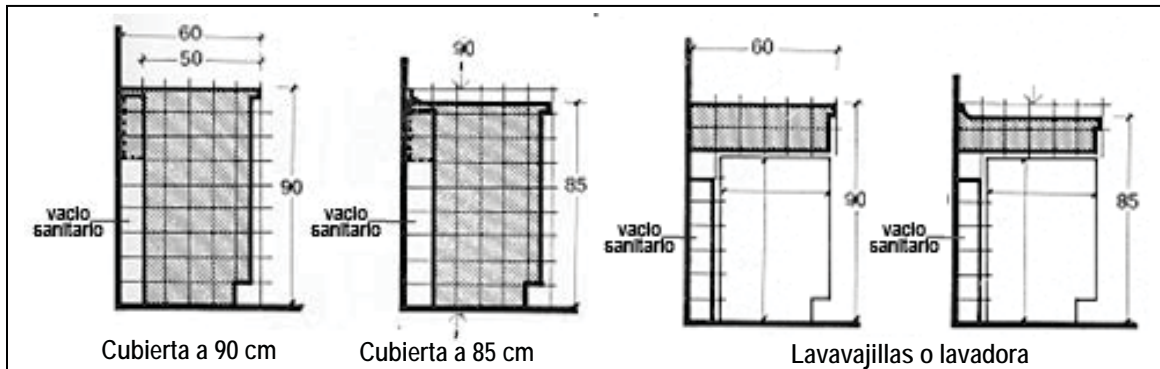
MUEBLES DE COCINA INTEGRAL BAJO CUBIERTA CON VACÍO SANITARIO EN EL FONDO
